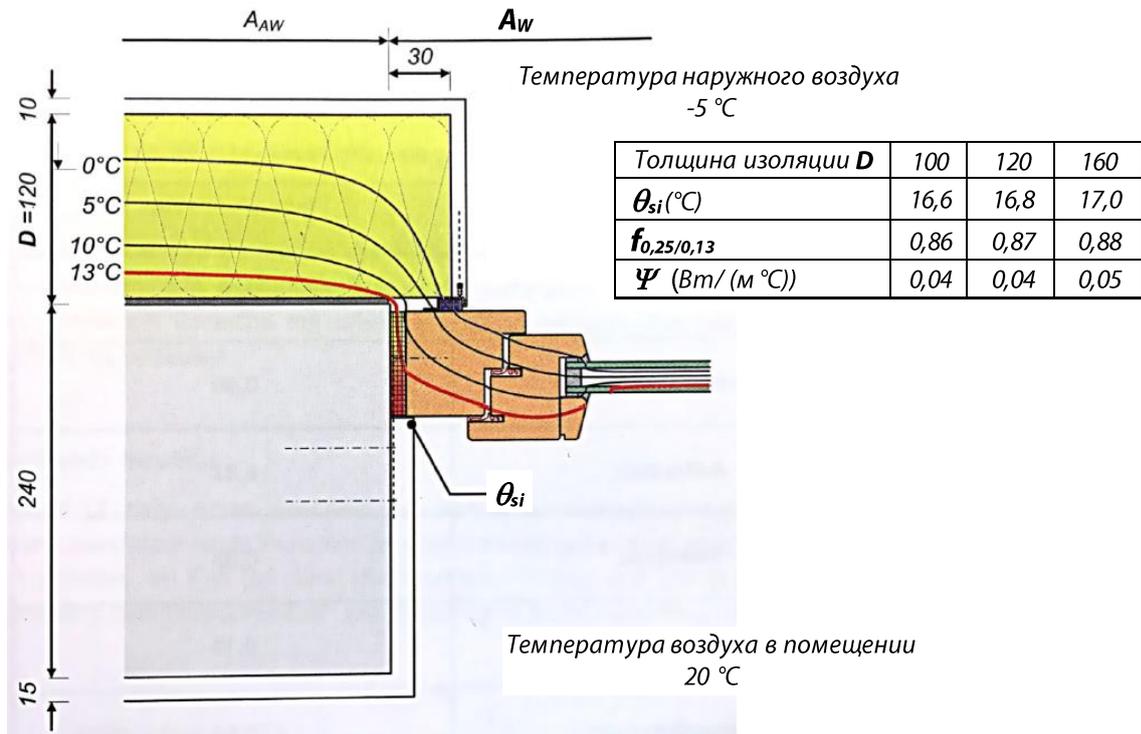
Бетонная стена с теплоизолирующей композитной системой, деревянное окно (сосна).
